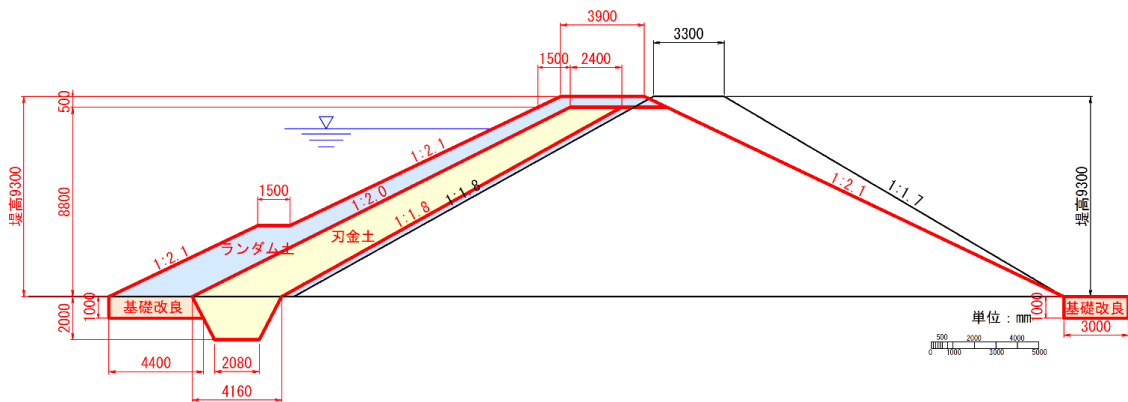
施工コスト算定用計画堤体断面（基礎改良工法）-2（H=9.3 m）
